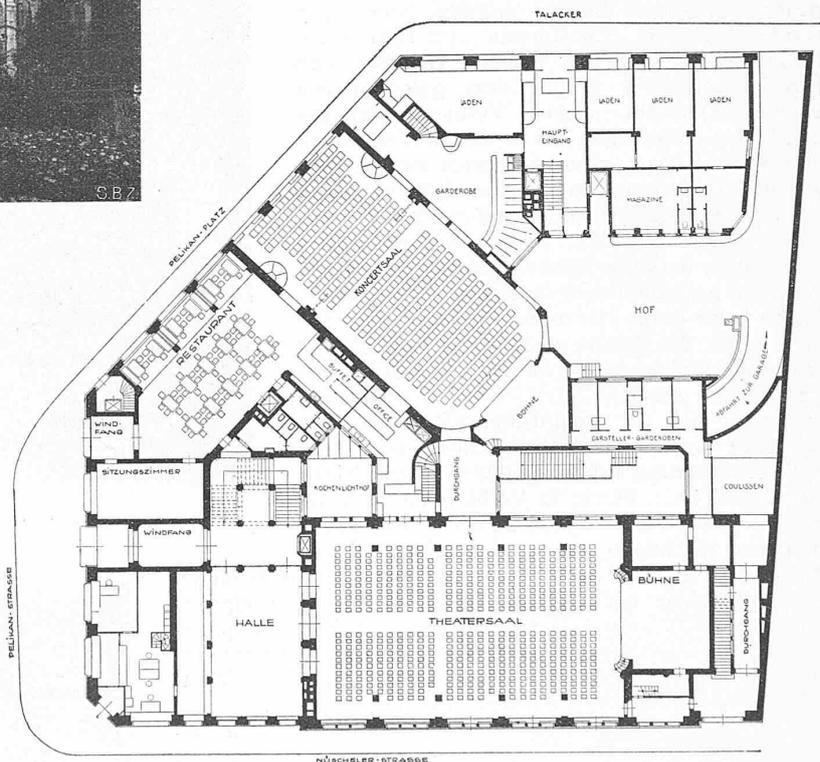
Erdgeschoss-Grundriss des ganzen Baublocks. (1:550; Cliché des K. V. Z.)
